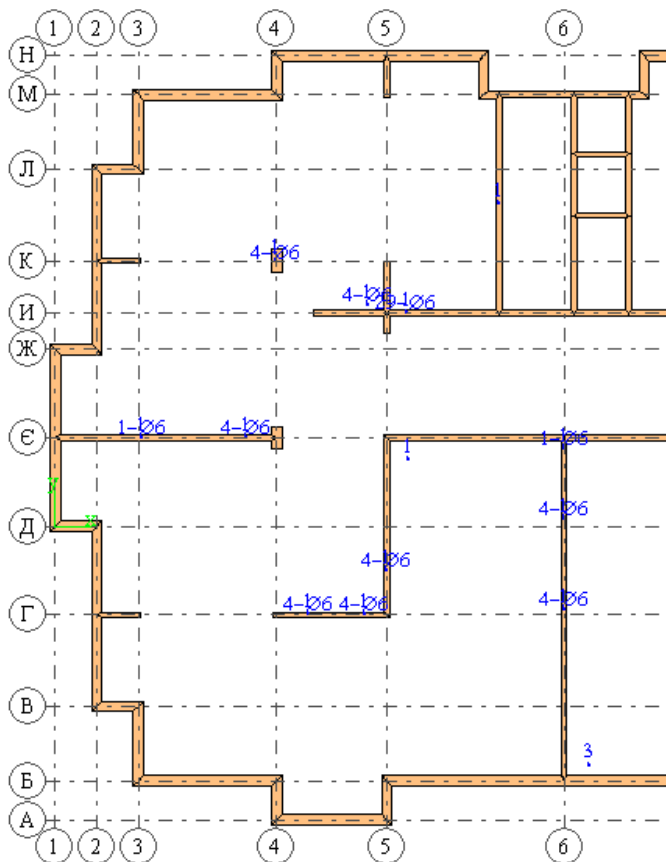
Характеристики армування стін першого поверху будівлі (фрагмент)
